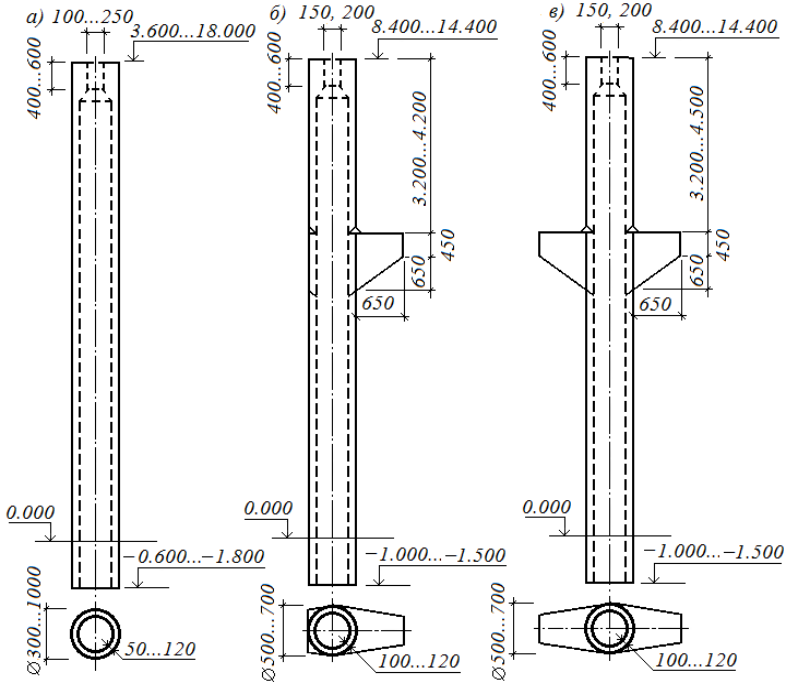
Збірні залізобетонні колони кільцевого перерізу для будівель: а – без мостових кранів; б, в – з мостовими кранами
